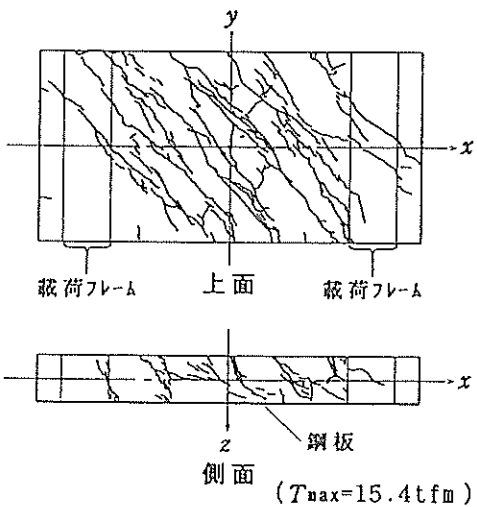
供試体 OS-16-150のひび割れ発生位置
